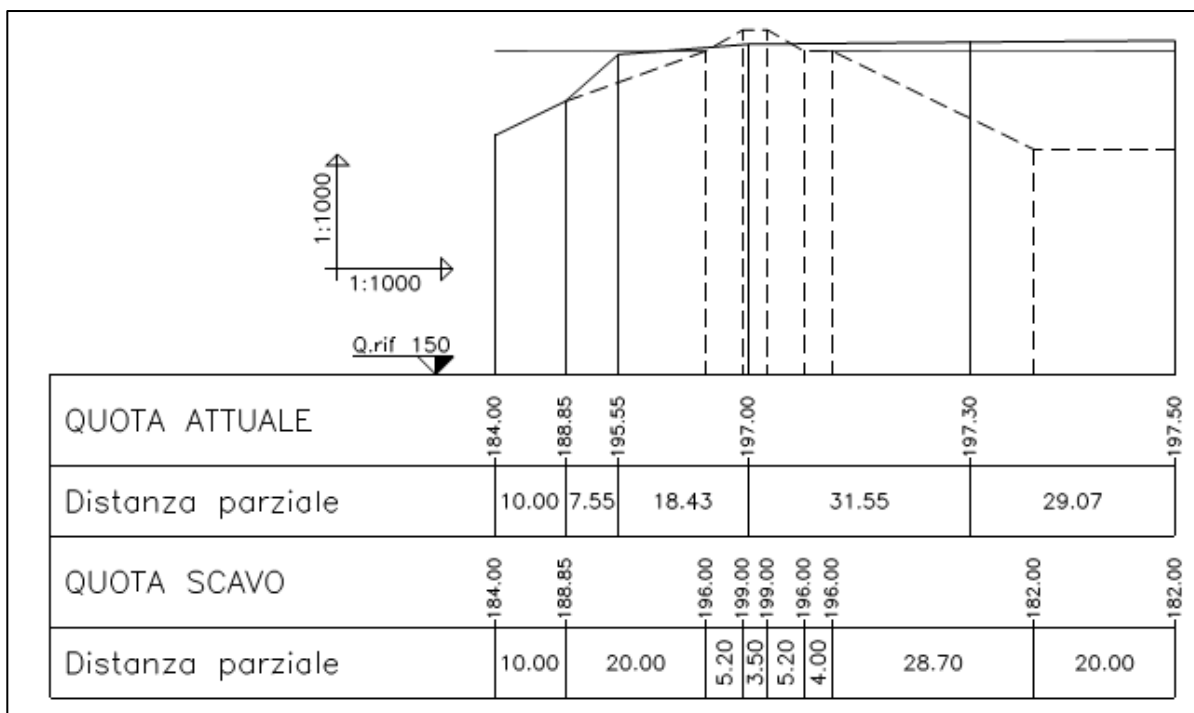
Sezione rappresentativa dell'esecuzione del setto, scala 1: 1.000. Estratto dall'Allegato 1.3 "Sezioni di stato attuale e finale", luglio 2015
